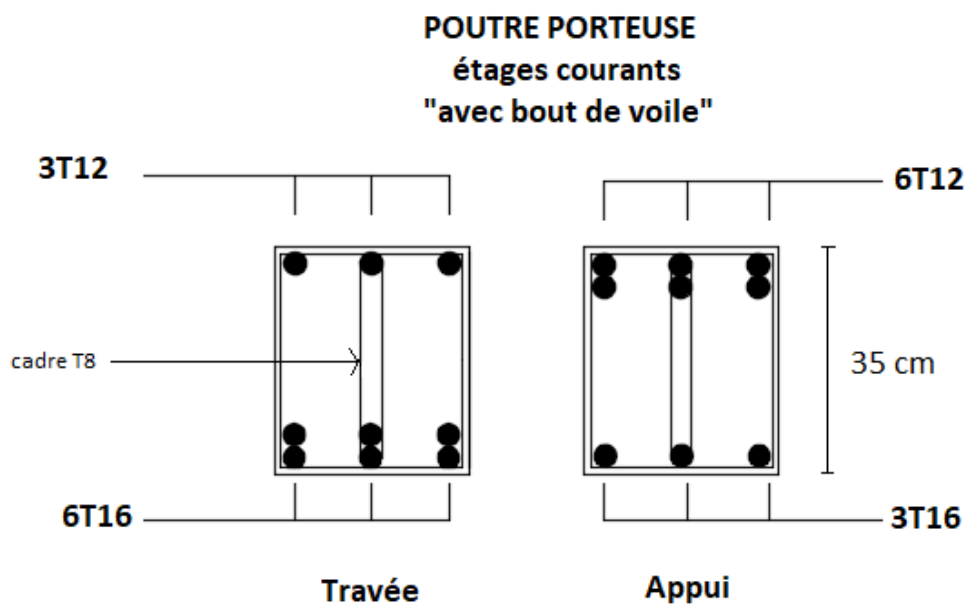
ferrailage des poutres porteuse Etage Courant avec bout de voile.
